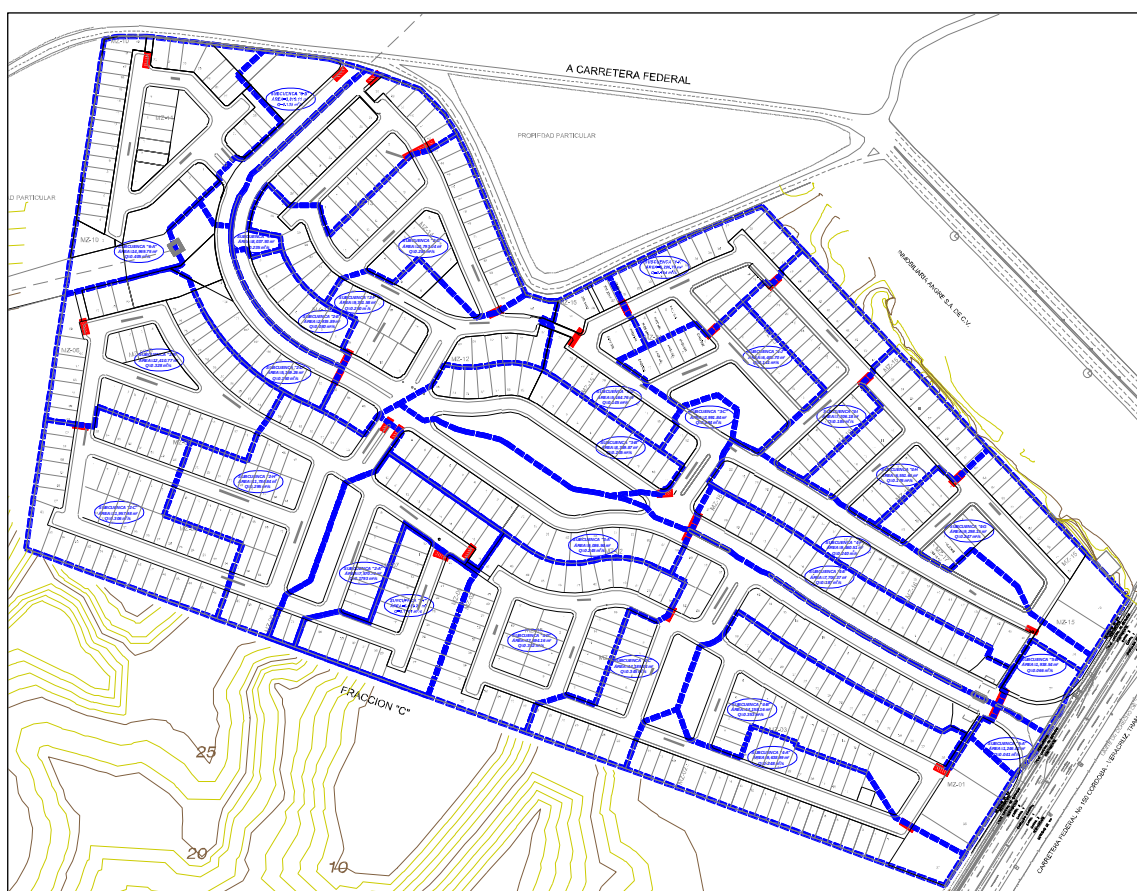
Determinación de las subcuencas de drenaje pluvial y ubicación de traga tormentas.
